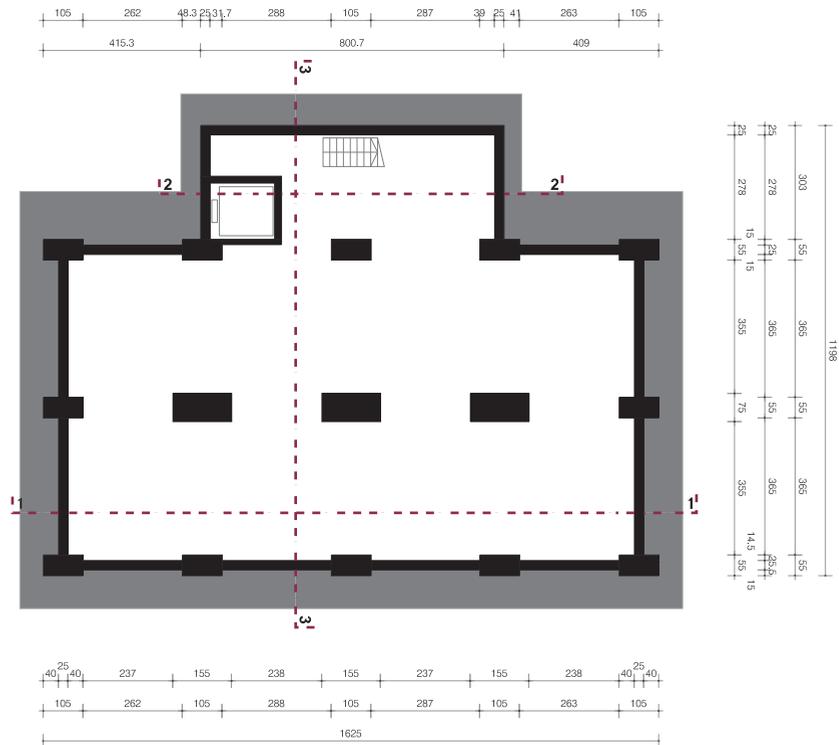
Grundriss Untergeschoss Bestand
